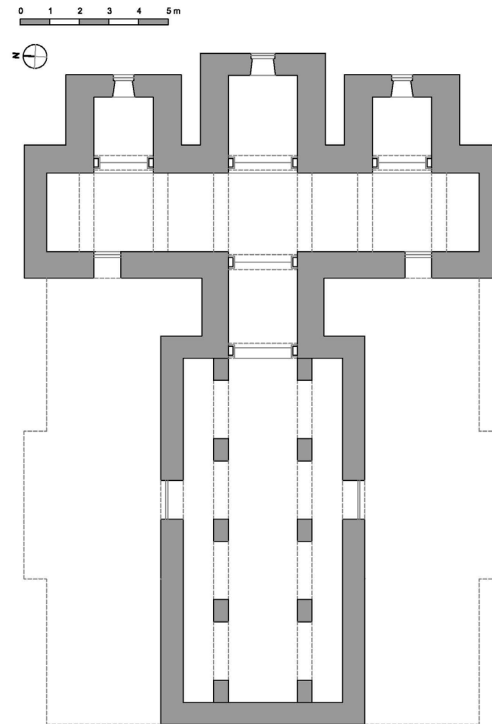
Planta de replanteo. Rectificación primera por aprovechar muros preexistentes (elaboración propia).
